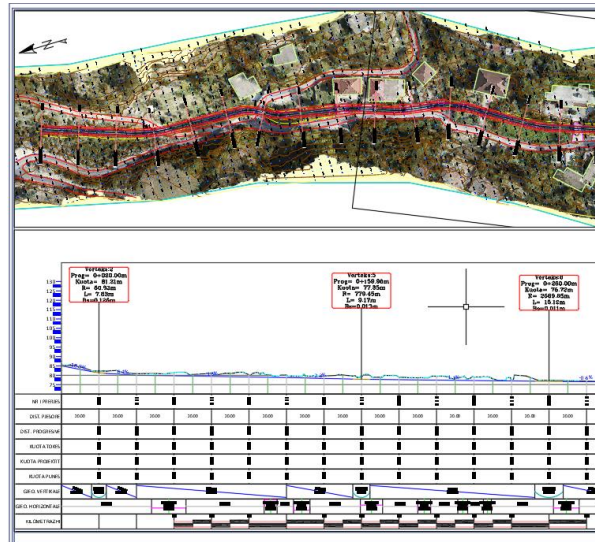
Planimetria e rrjetit te kanalizimeve te ujrave te ndotura
